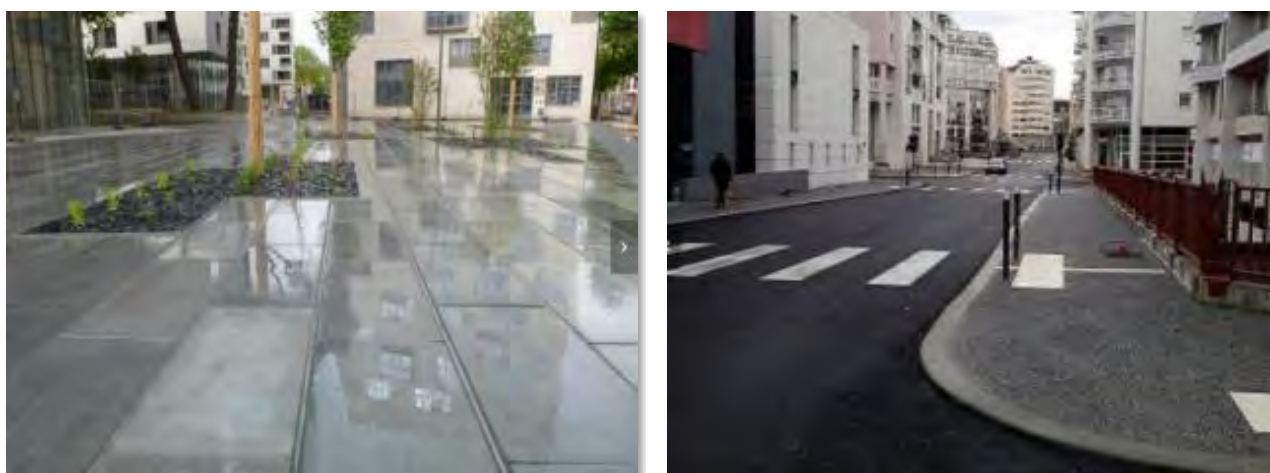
Proyecto de Burdeos, Francia Pavimentos de Tudela (izquierda) - Proyecto Pau, Francia pavimentos de Tudela (derecha).
